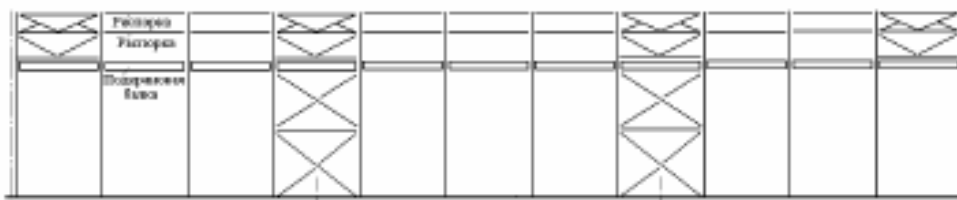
Схема розташування вертикальних зв'язків колон по довжині температурного блоку опалювального й неопалюваної (у дужках) будівлі
